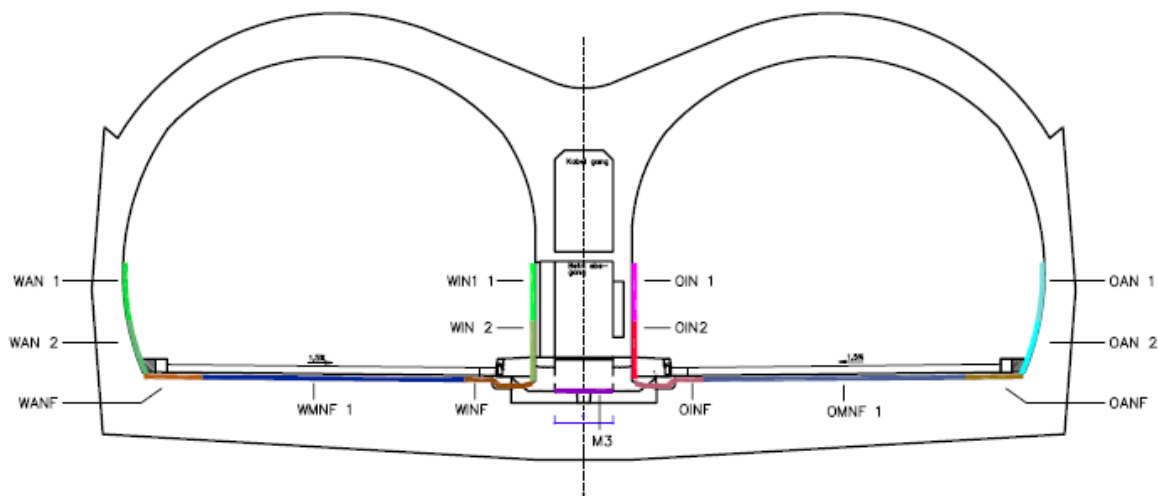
Schematische Darstellung Tunnelröhren Querschnitt geschlossene Rampenstrecke [2]
